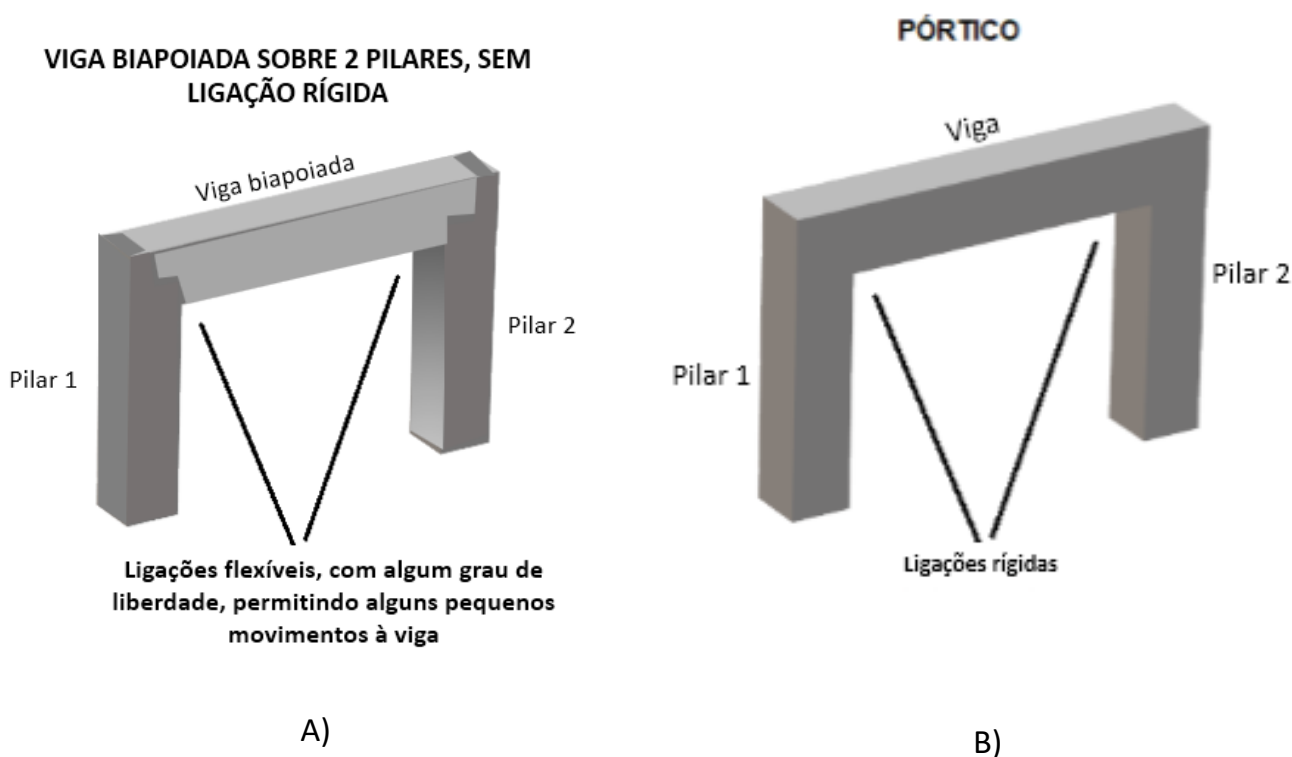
Viga biapoiada (A) e pórtico plano formado por dois pilares e uma viga.
